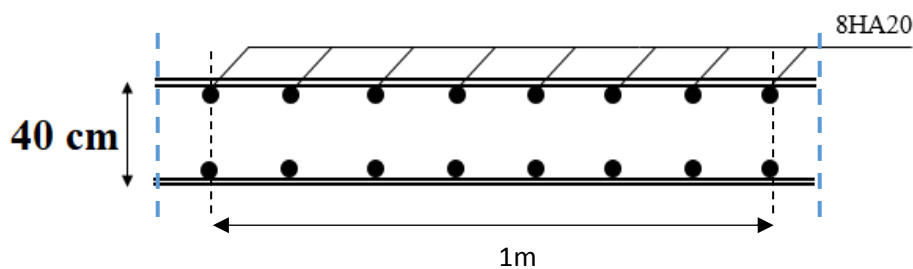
Ferrailage de la dalle du radier sens x-x.
